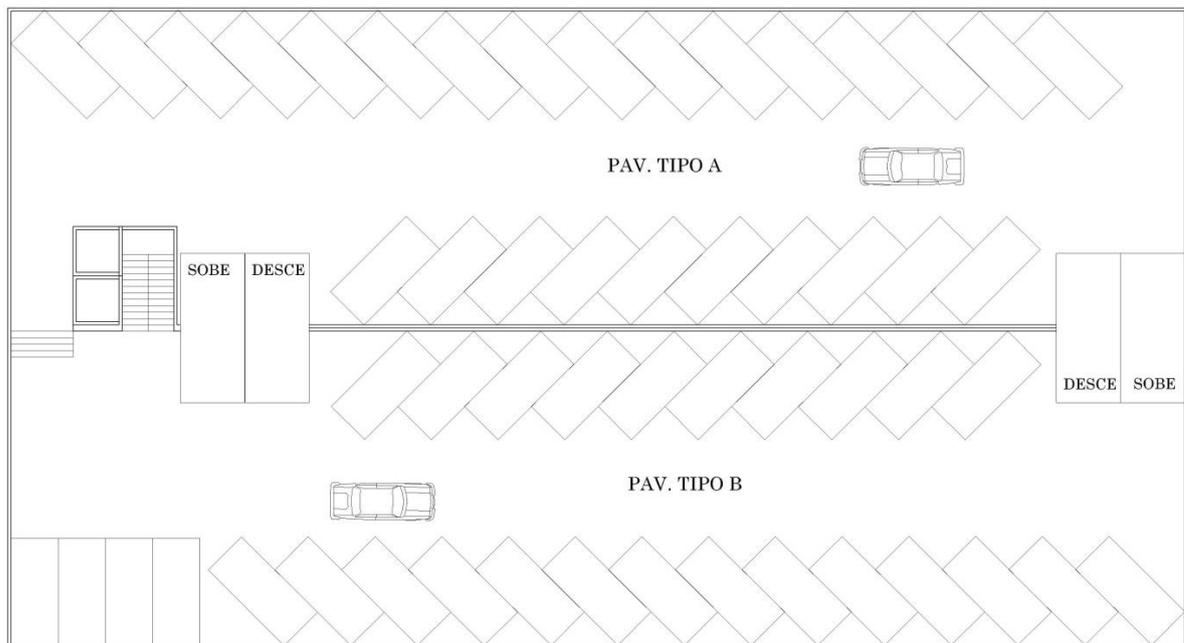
Planta baixa esquemática do térreo A e o subsolo.
